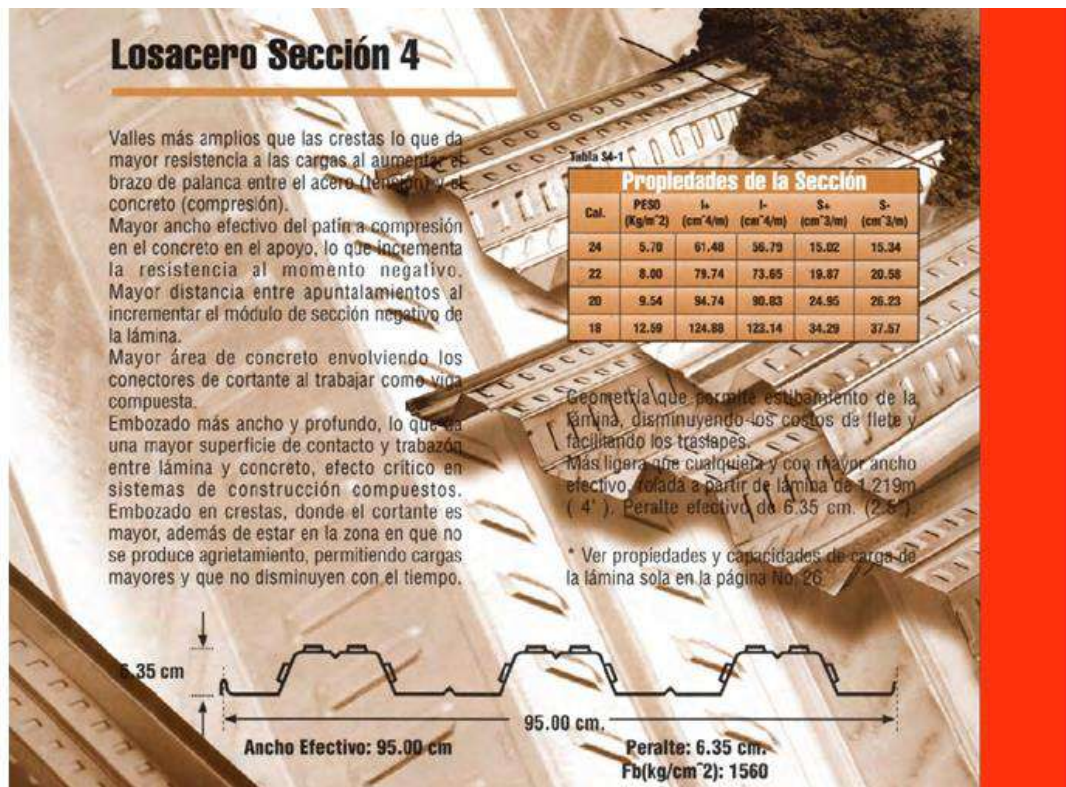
DETALLE DE LAMINA DECK METALICO.
